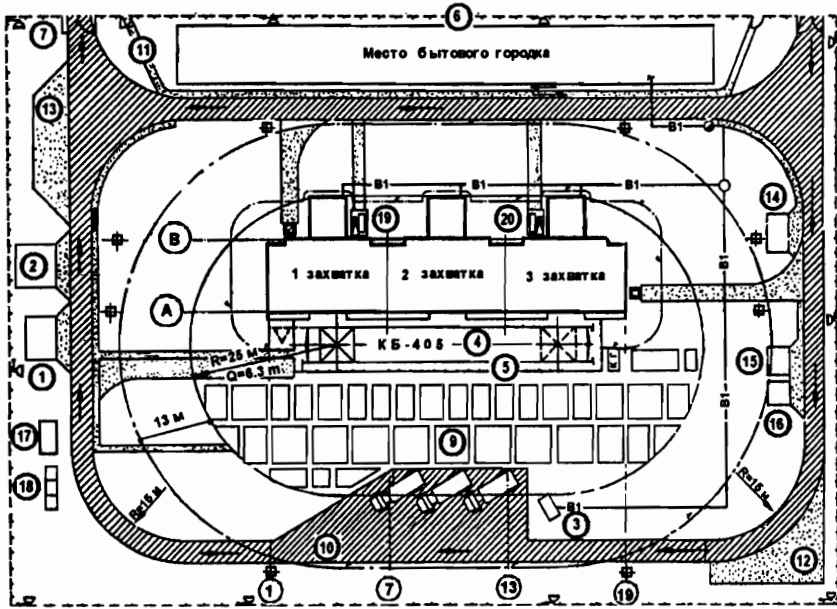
Строительный генеральный план на возведение надземной части здания
